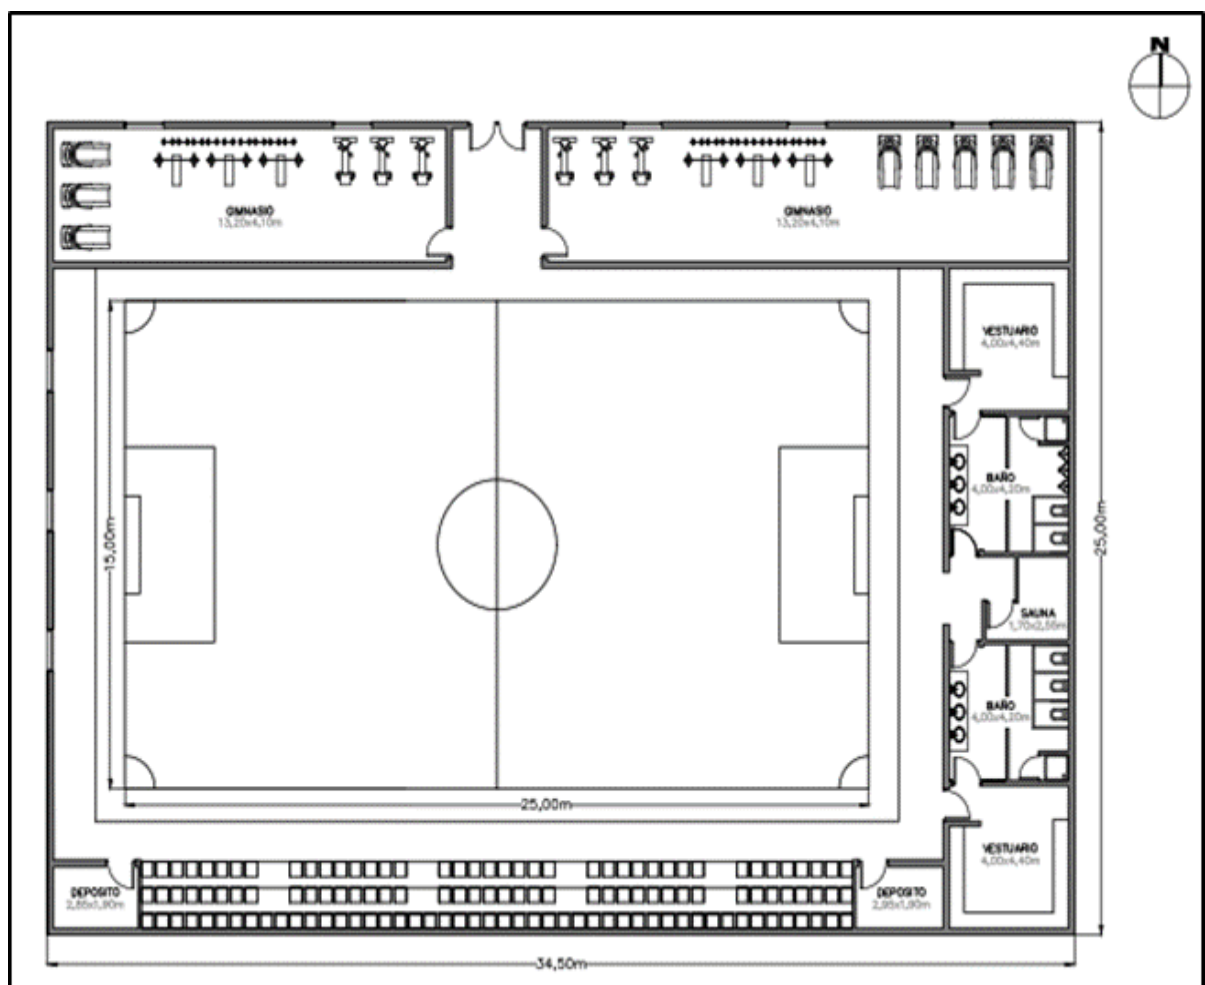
vista en planta del Alojamiento de Emergencia / Gimnasio
